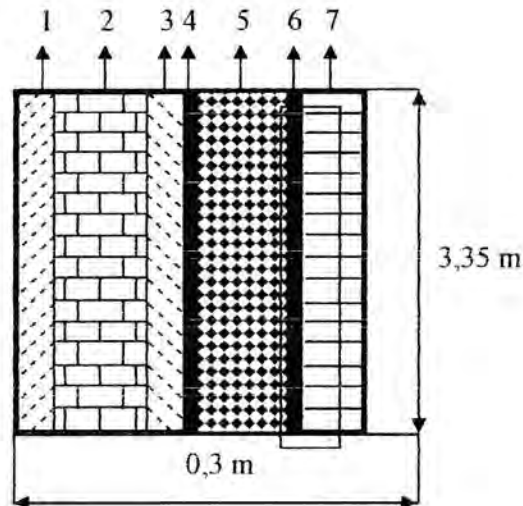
,8 Dimensi Ruang Cold Storage Sebenarnya
